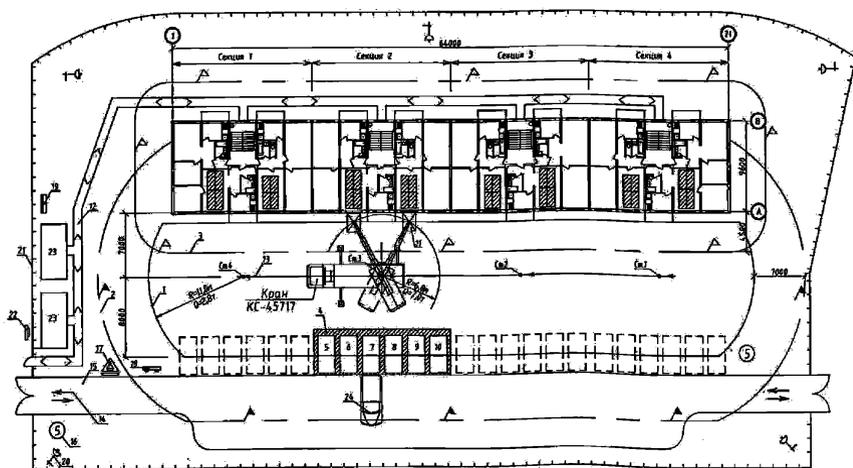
Стройгенплан разбираемого жилого дома серии П-32
